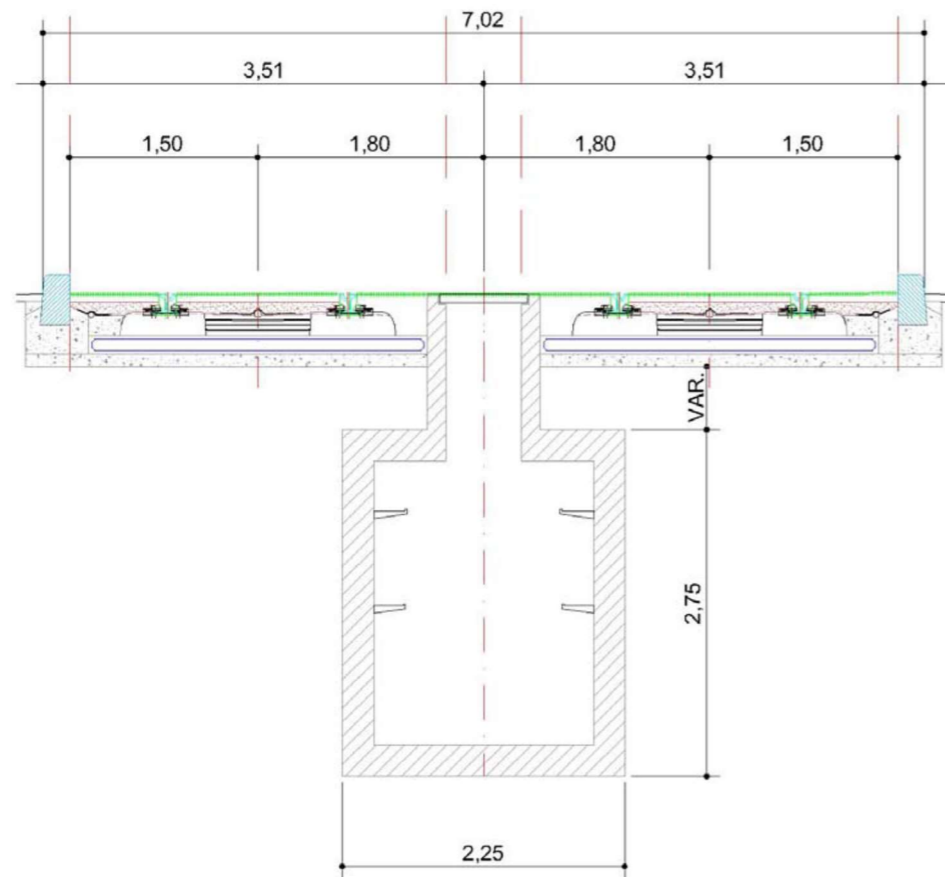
Sección galería de servicio. Fuente: MTSA
